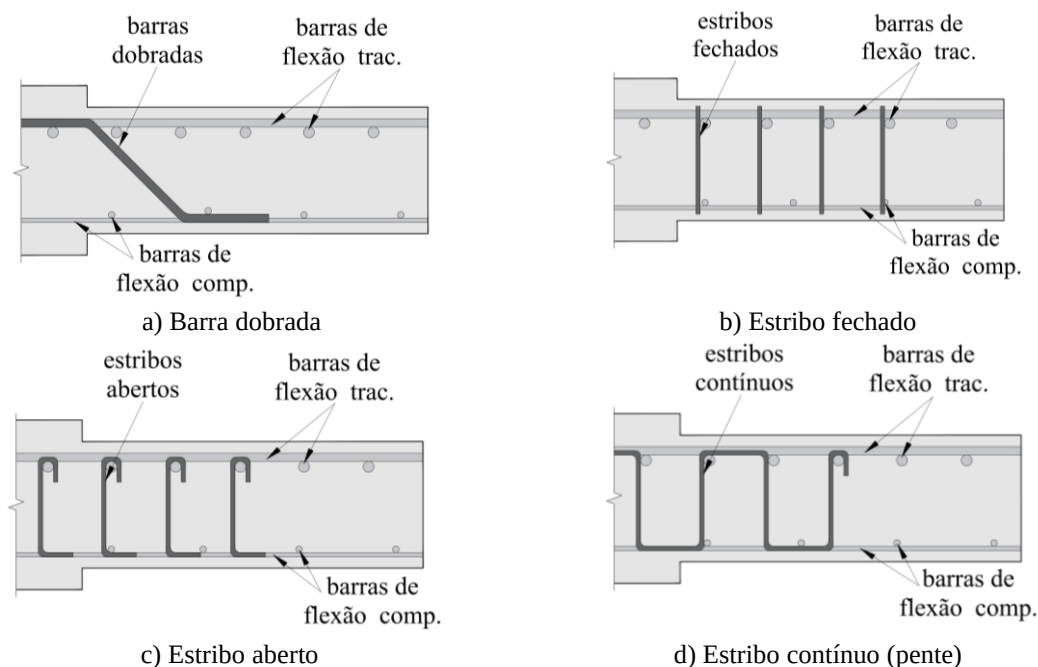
Tipo de armaduras de cisalhamento. (adaptado de Pereira Filho, 2021)
